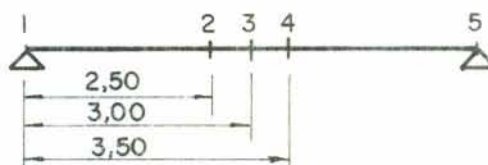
Seções dadas por POSIÇÃO em vigas
